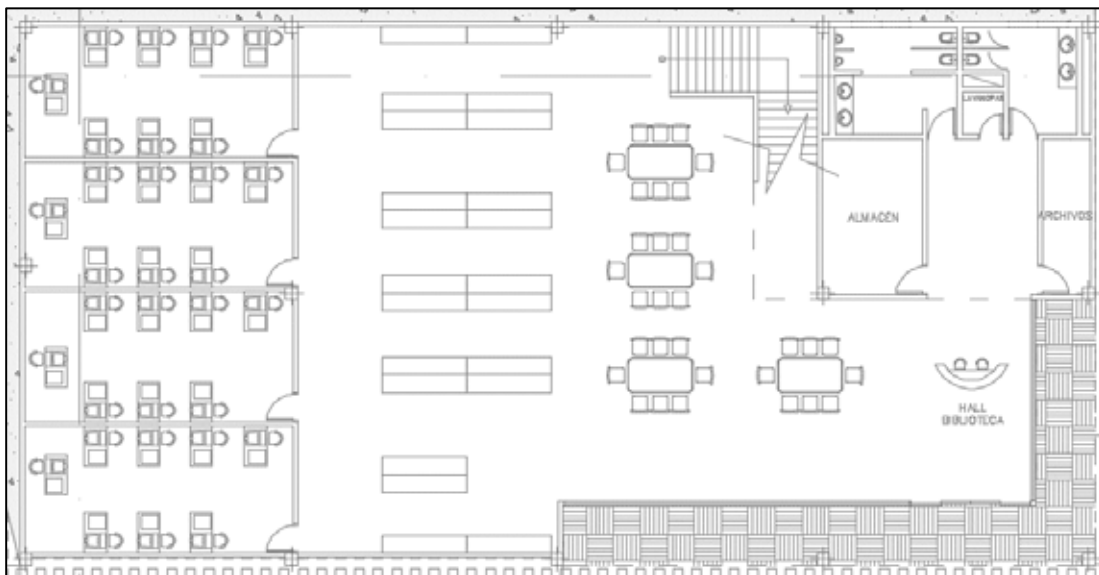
Planta Baja Módulo Cultural. Fuente: Propia autoría. (2018).
